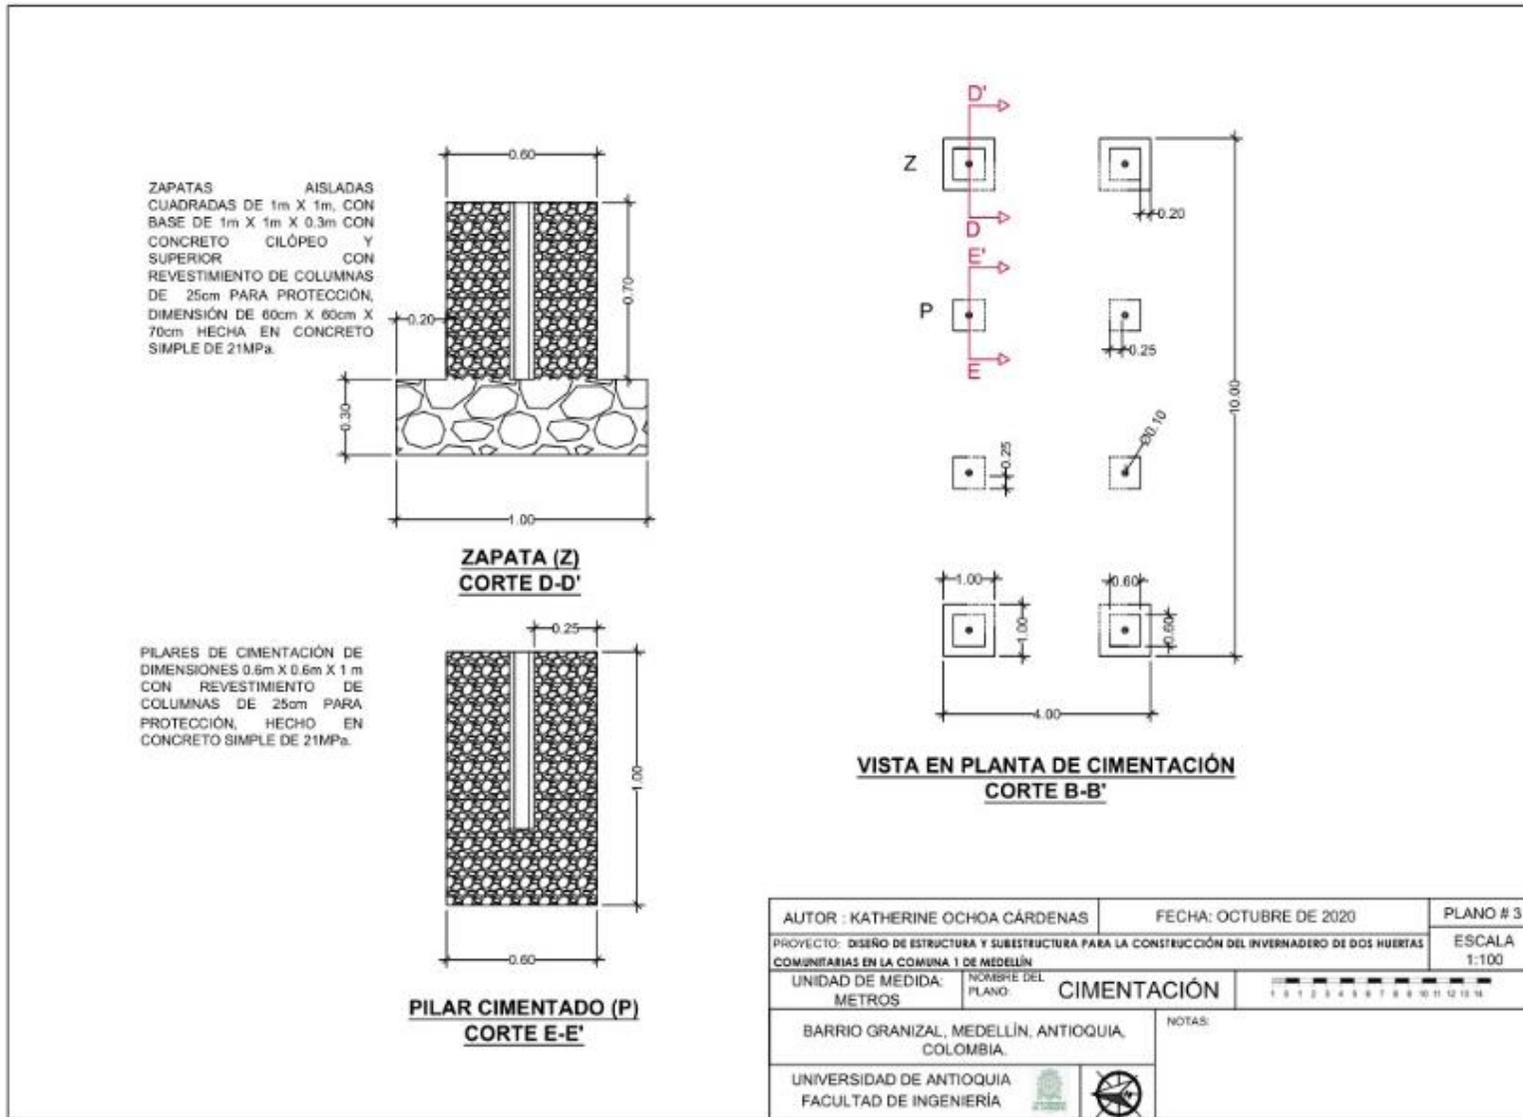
Plano#3 Cimentación, Barrio Granizal.
